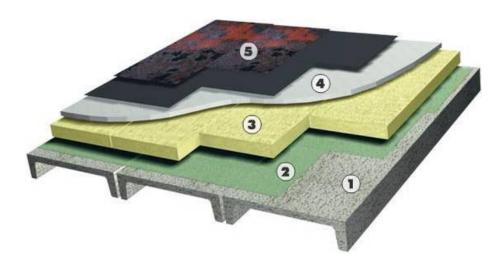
Структура плоской кровли: I — плиты покрытия; 2 — слой пароизоляции; 3 — слой утеплителя; 4 — железобетонная стяжка; 5 — слой гидроизоляции (рулонной или наплавляемой)
